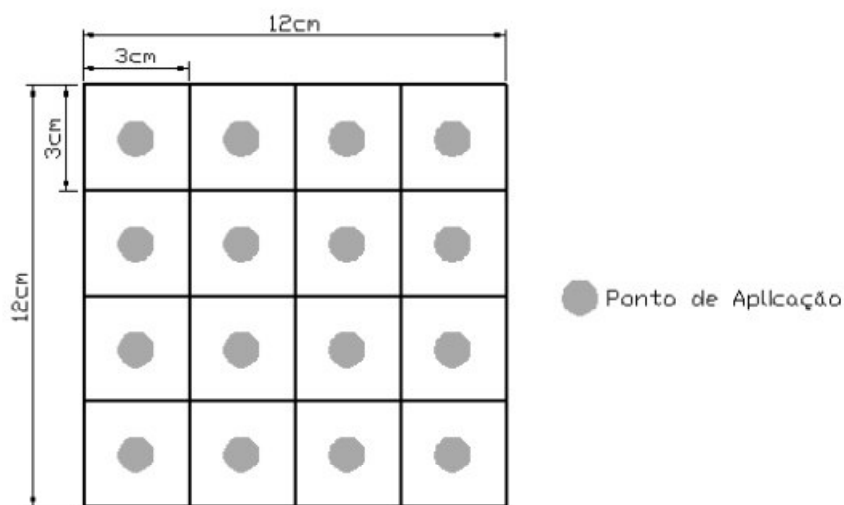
Esquema de aplicação do ensaio (Sahuinco, 2011)
